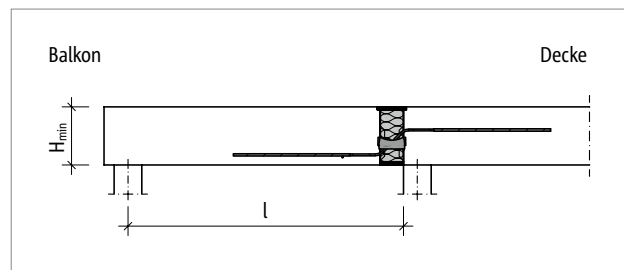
Schöck Isokorb® T Typ QL-V2 bis V6: Statisches System
